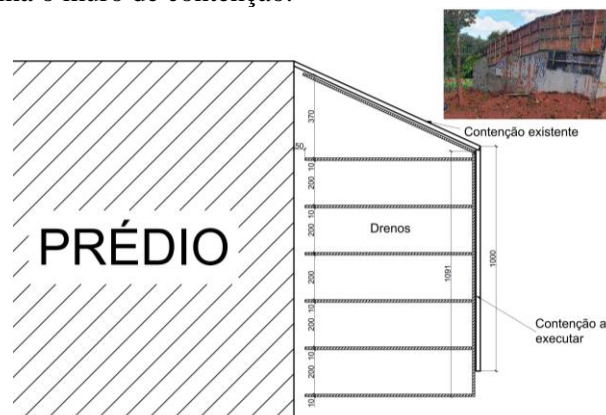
Proposição do local dos drenos e estrutura de contenção.
